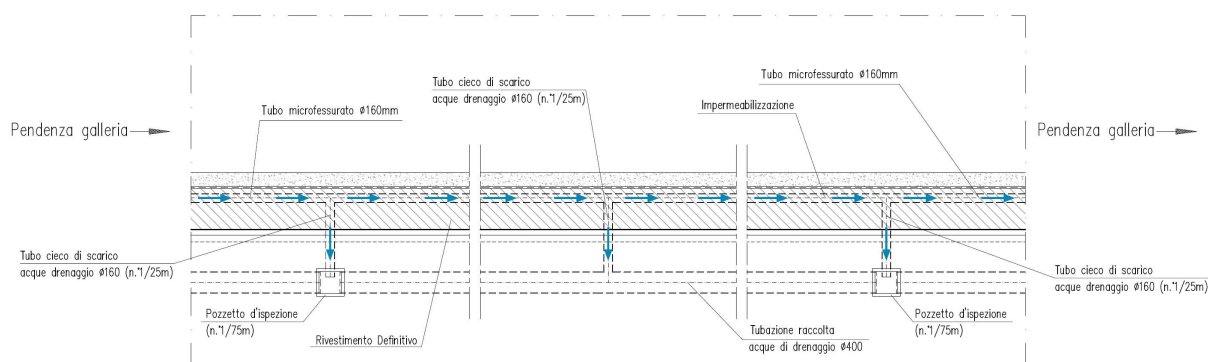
Impermeabilizzazione TIPO 1 -Schema planimetrico smaltimento acque bianche
